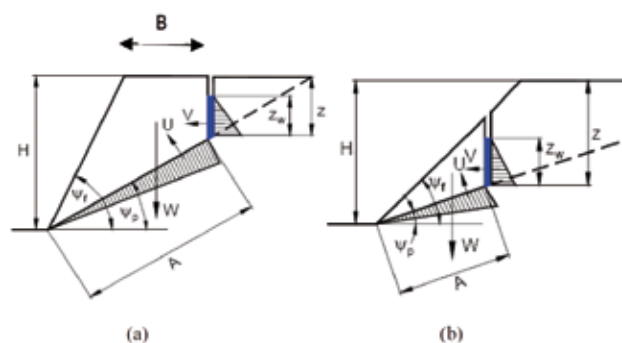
Falla plana con grieta de tracción en (a) corona del talud y (b) cara del talud (adaptado de Hoek y Bray 1981)
